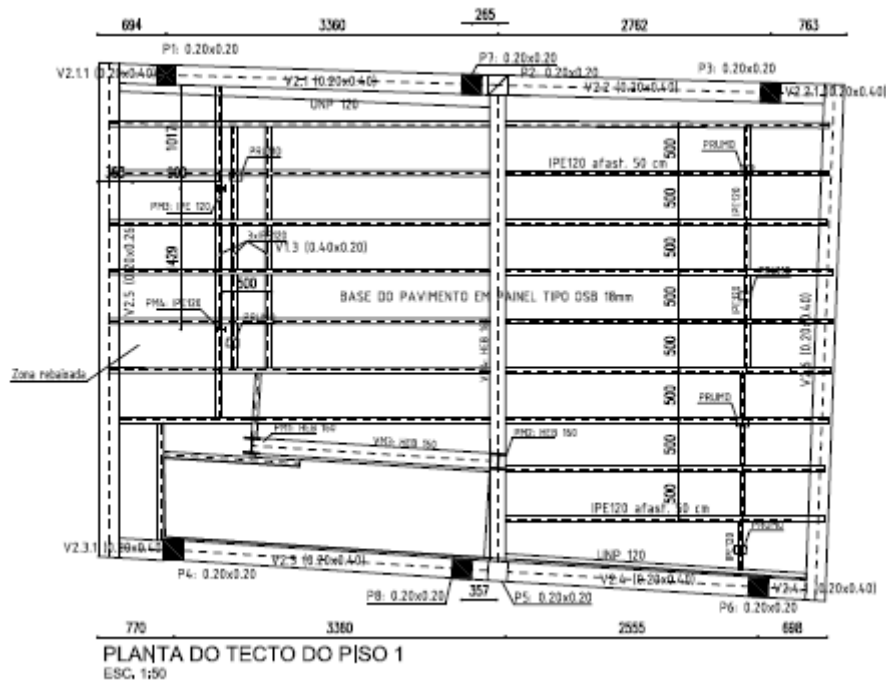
Planta do teto do piso 1 (Nunes, projeto de estabilidade, 2016)
